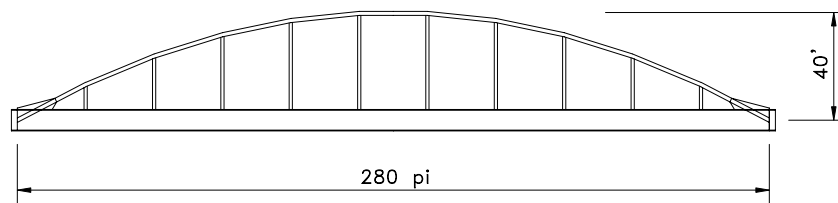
Pont sur la rivière Châteauguay à Ormstown
